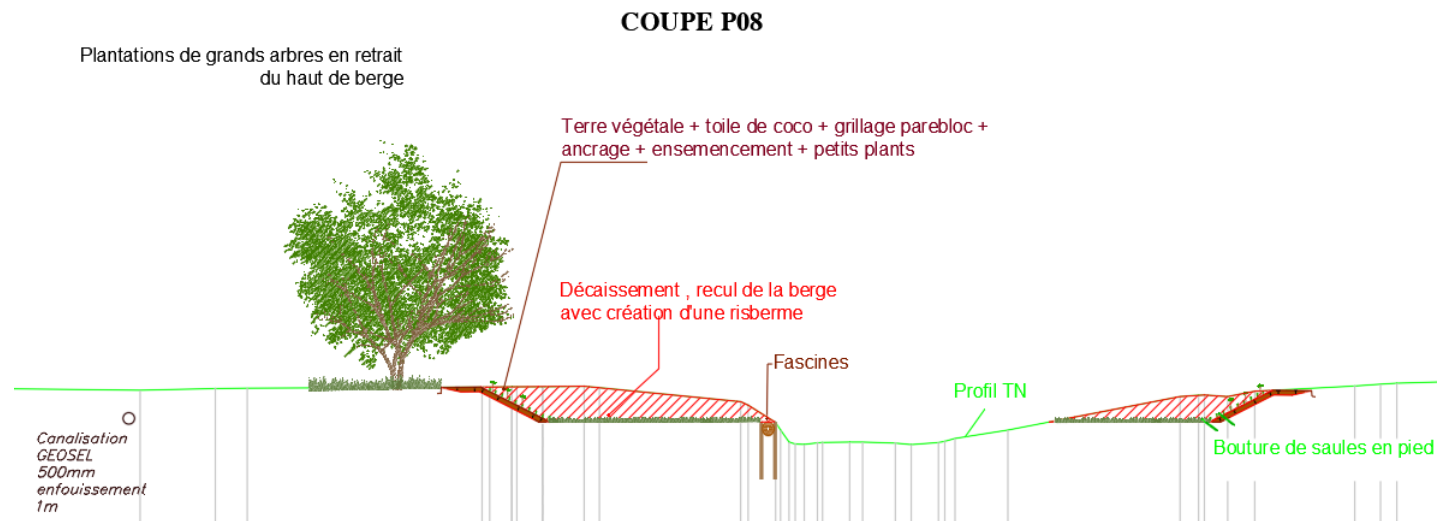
Secteur 4 – Action 8, profil type P08 (élargissement par rive gauche et par rive droite)
